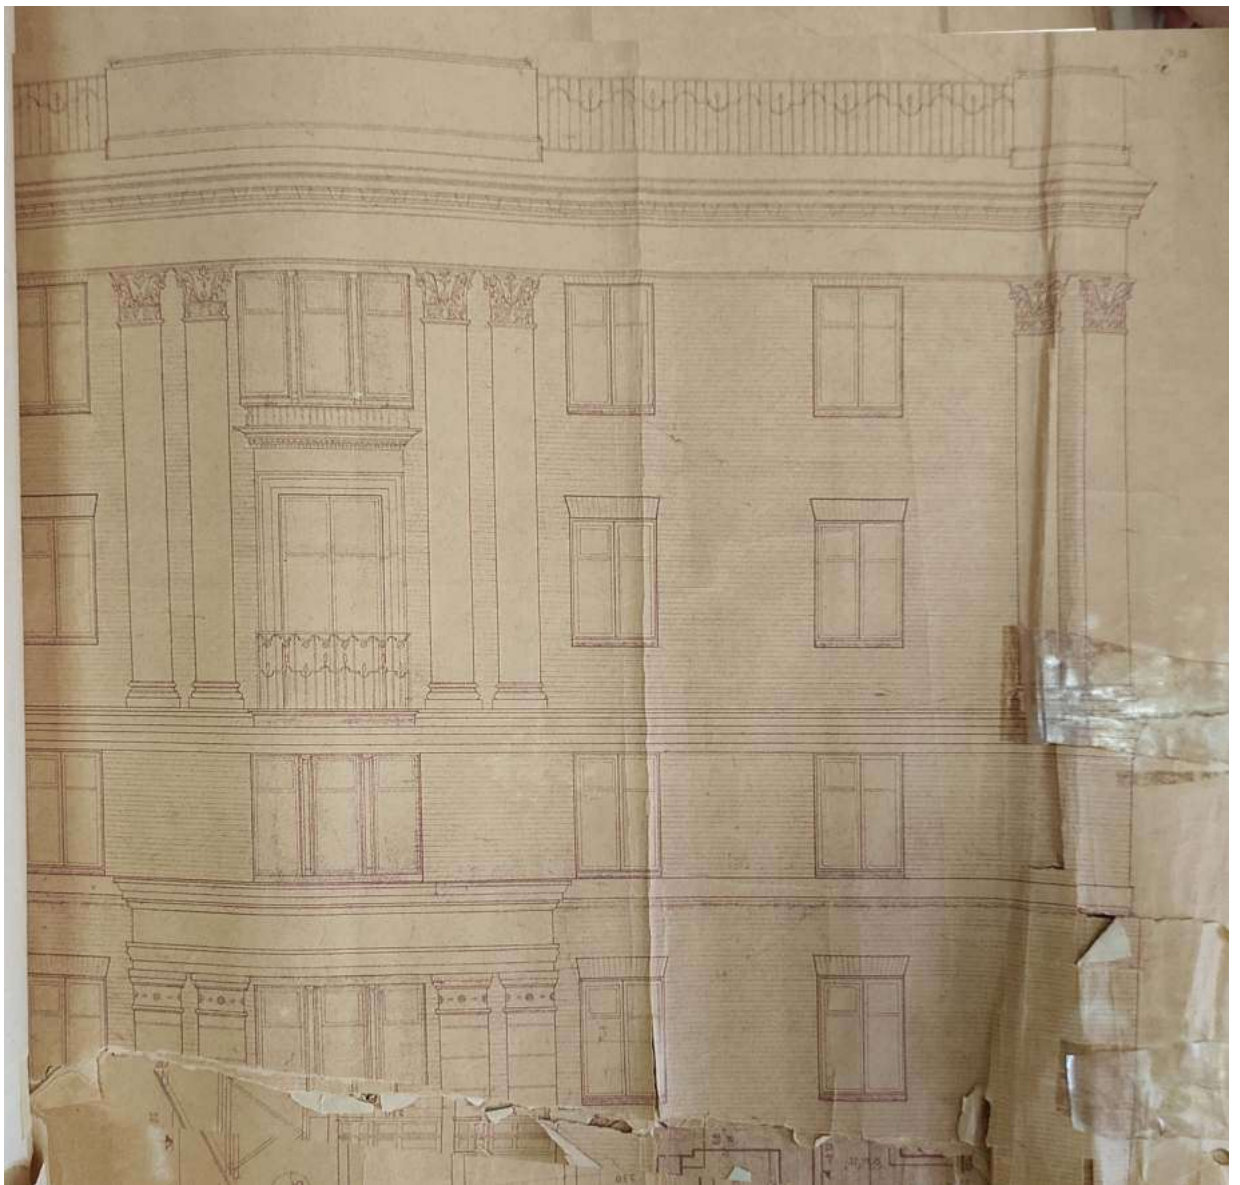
Фрагмент типового проекта № 1-409-2. Фрагмент главного фасада
